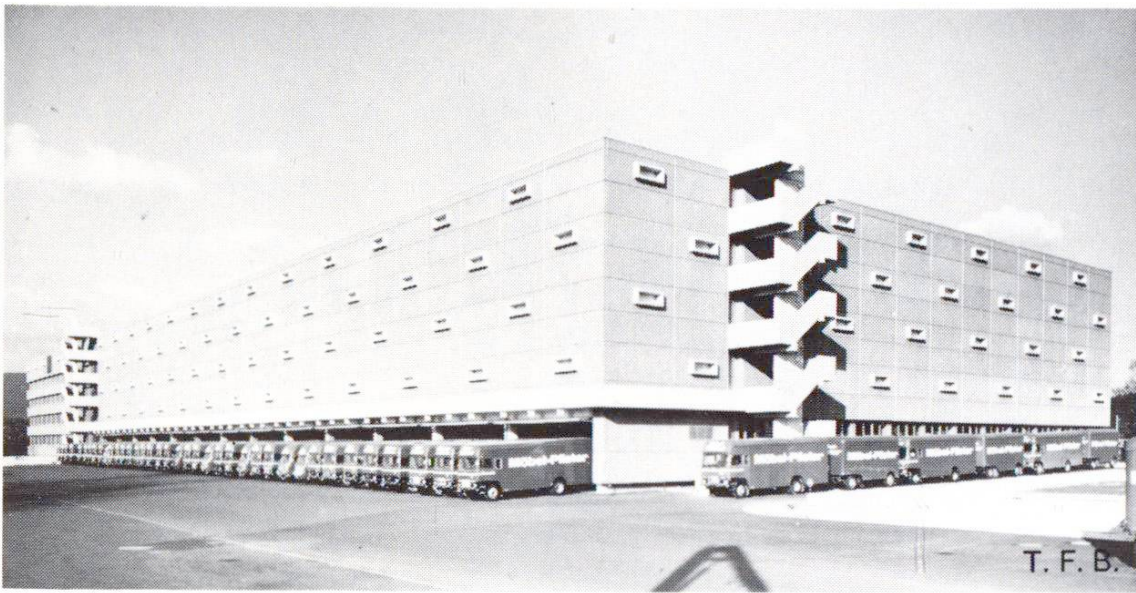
Dépôt de meubles à Suhr. Dalles préfabriquées en béton lavé.
